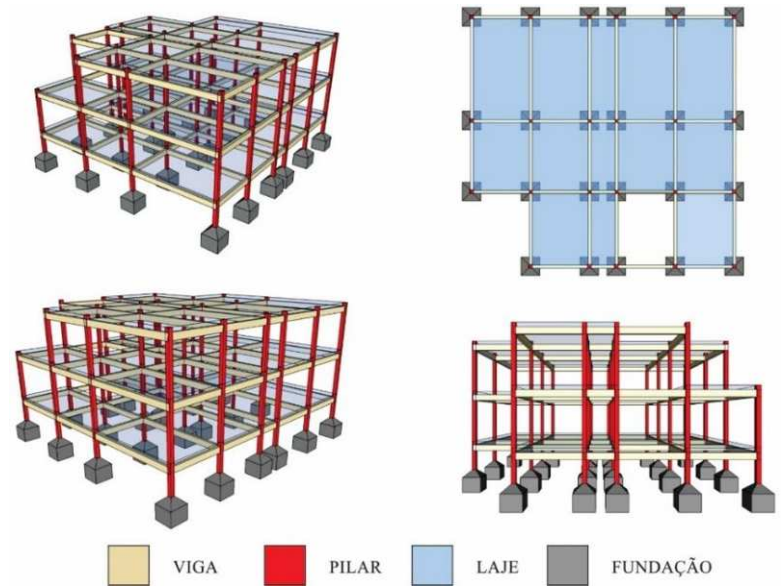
Sistema estrutural do prédio principal (Fonte: Arquivo pessoal)
